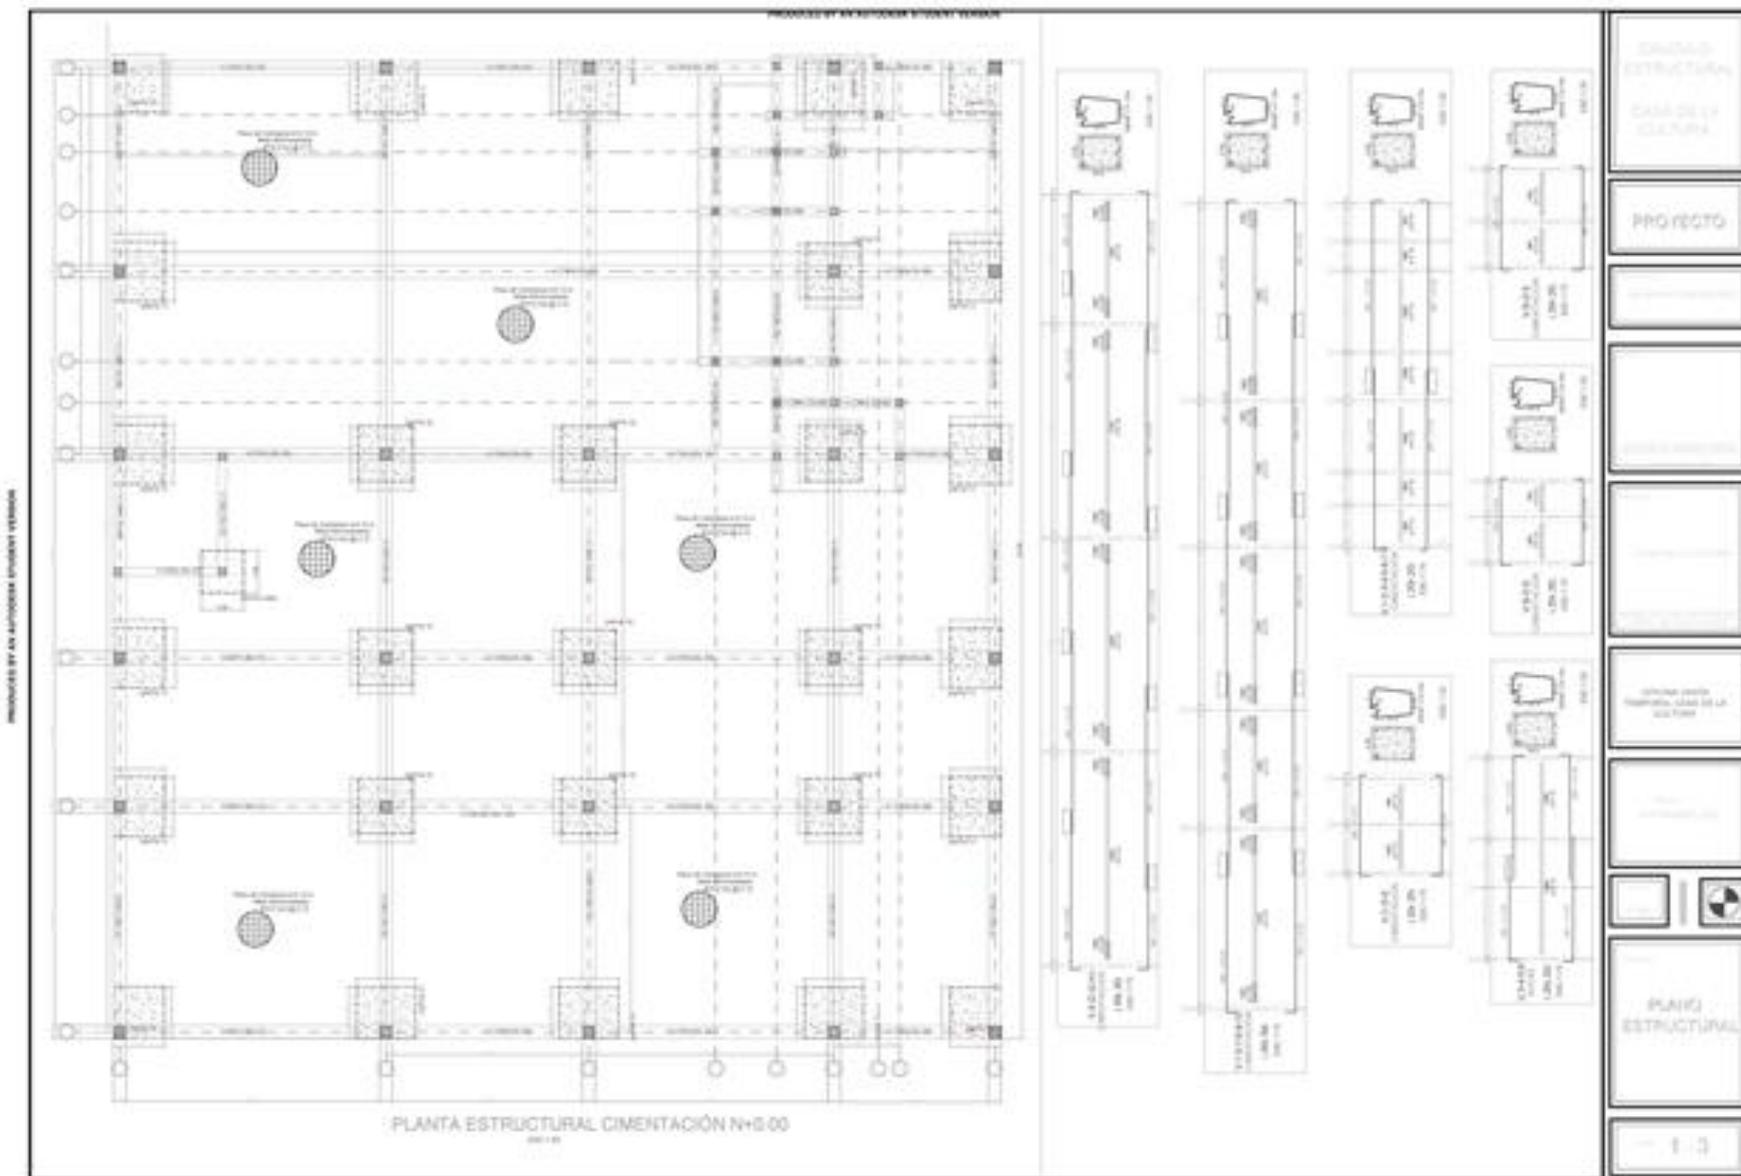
Plano de cimentación. Fuente: UT CASA DE LA CULTURA
